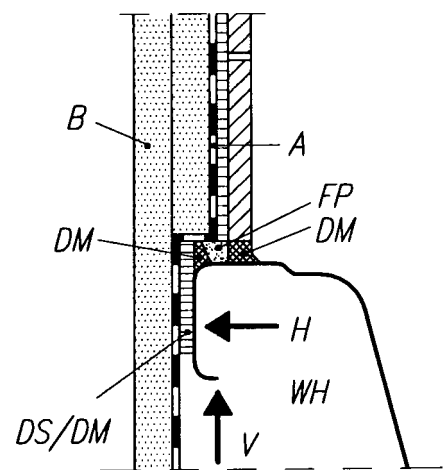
Beispiel für Anschluß Duschtasse – Duschenwand unter Verwendung spezieller Befestigungselemente (Wandhalterung WH, Einzelheiten hierzu s. Abschn. 6.6.1); Voraussetzungen: Verfliesen nach dem Aufstellen der Duschtasse, Wandbeplankung B zweilagig; Bewertung: Neben Bild 6.7b die sicherste der hier gezeigten Ausbildungen (vgl. Tab. 6.2);
